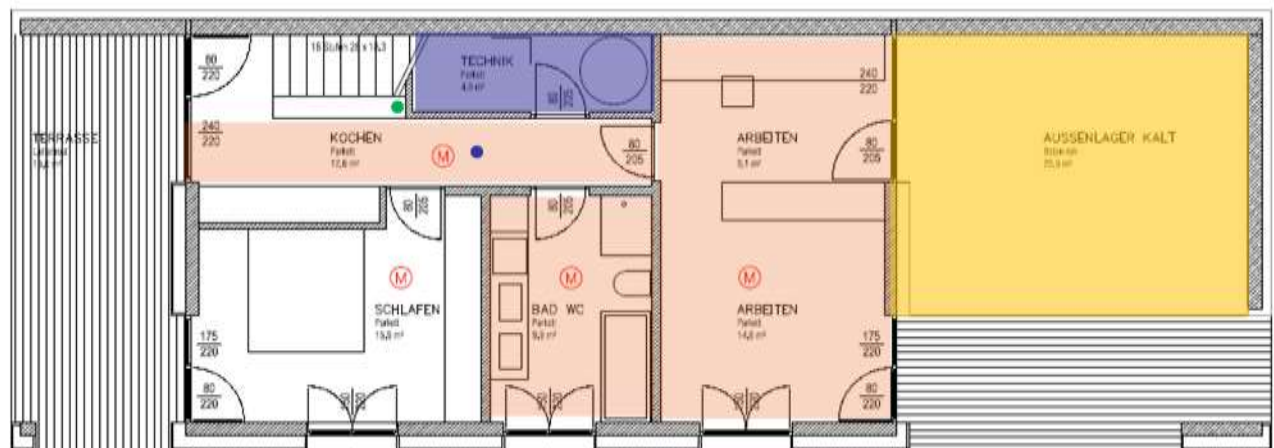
Grundriss des Untergeschosses, blau: Technikraum (Quelle: Einreichplan, Architekt DI T. Getzner)
